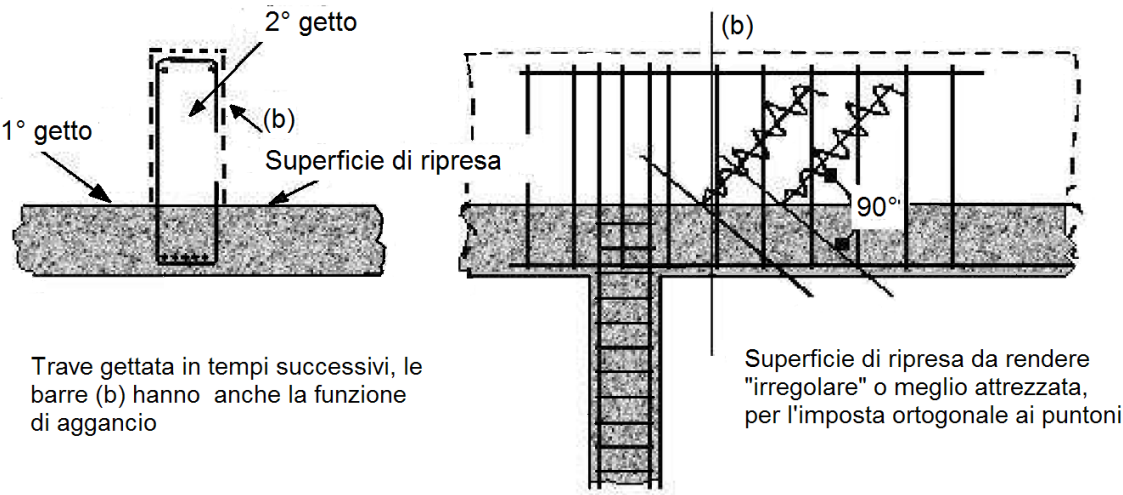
Modalità di ripresa del getto su travi di spessore elevato
